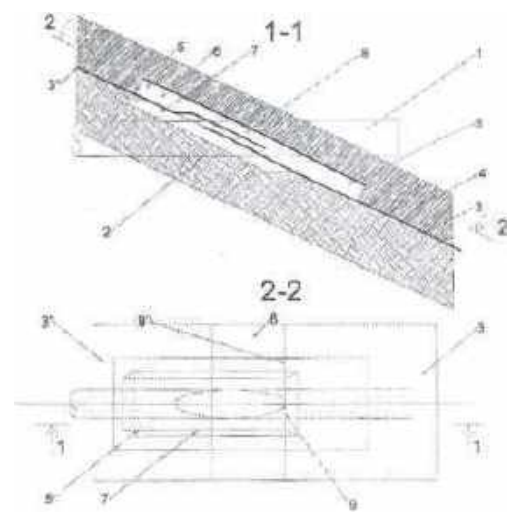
Вузол пересічення екрану на укосі з трубопроводом (варіант з улаштуванням з'єднувального шва в місці пересічення)
